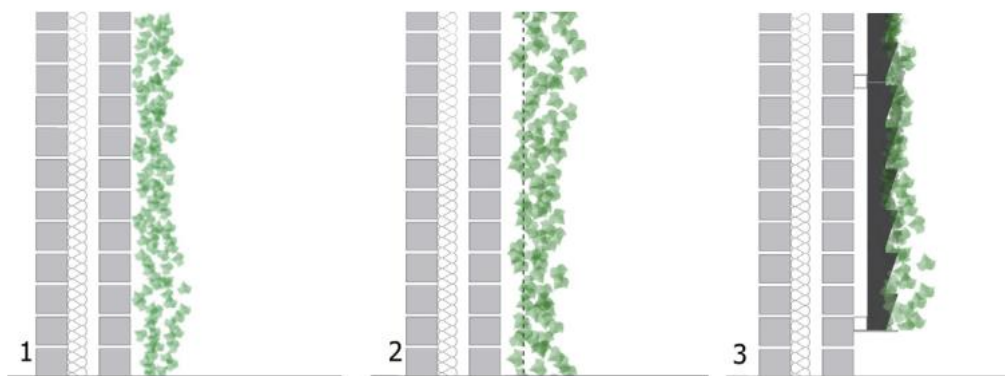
1- Fachada verde direta, 2- Fachada verde indireta, 3- Sistema de muro vivo. Fonte: PERINI, ROSASCO (2013) adaptado
